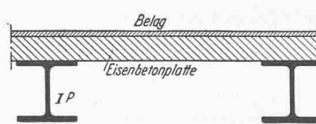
Schwerdecke aus Walzträgern und Eisenbetonplatte
